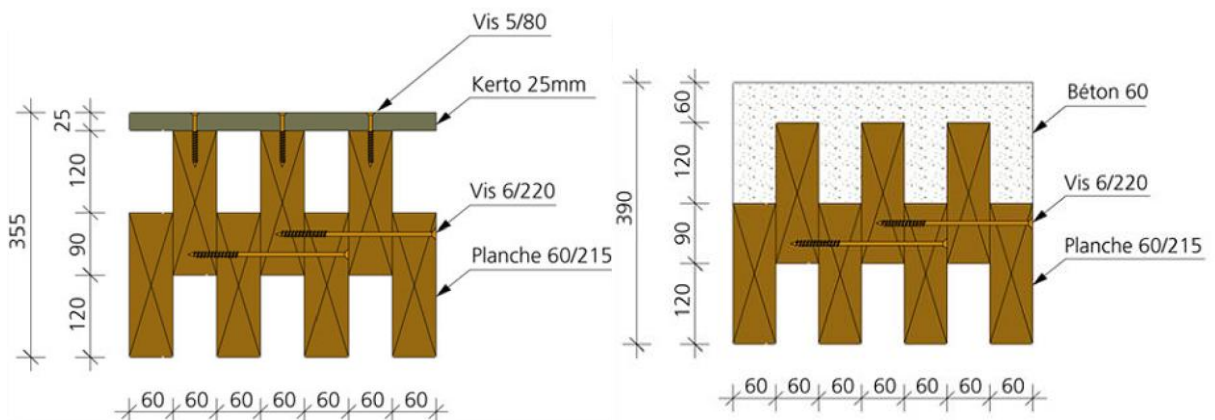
(a) Solive O'portune, en planches vissées décalées, pour des portées de 5 m à 9 m (b) la solive D-Dalle, la double dalle mixte bois-béton pour des portées de 8 m à 15 m [10].
